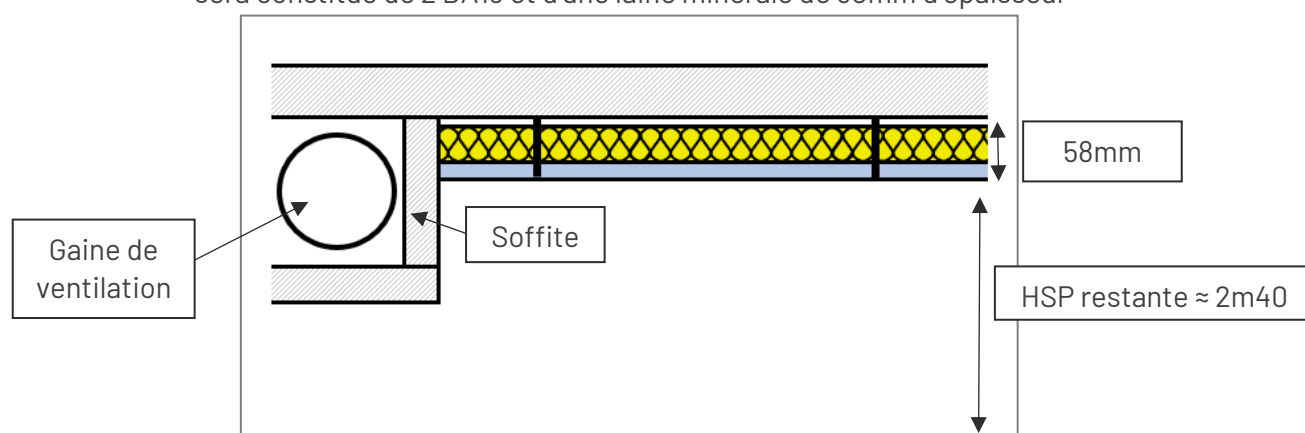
Schéma – Détail du soffite et du plafond d'isolement du Foyer
